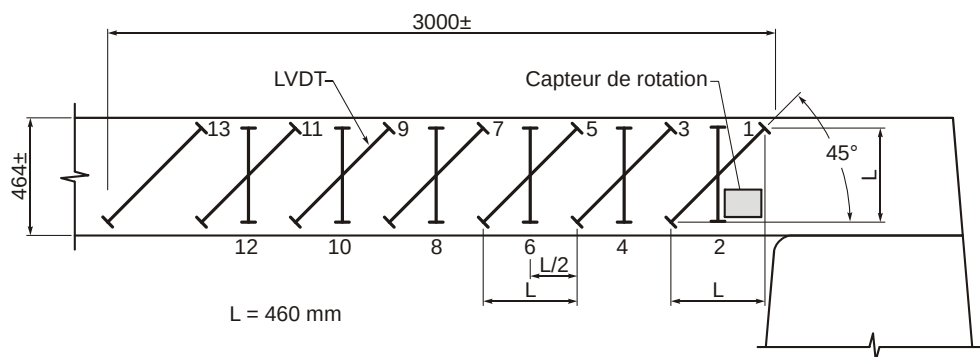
Disposition des capteurs LVDT sur la travée Nord – Essai 1
